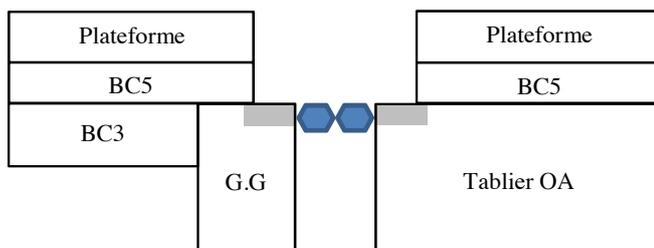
Joint de dilatation sur voiries séparées (joint de chaussée sans joint de plateforme)
